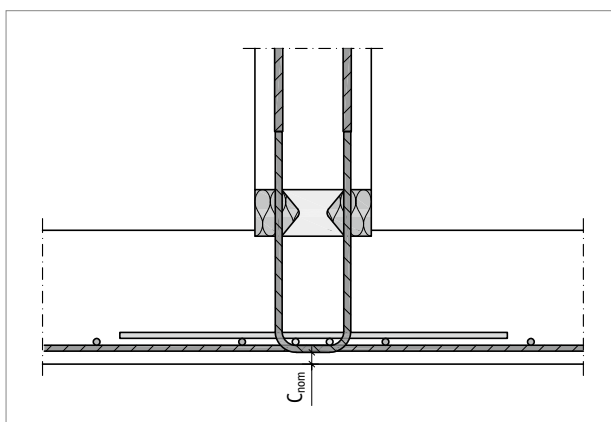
Schöck Sconnex® Typ W-N1T1-BW: Die zweite Bewehrungslage ist in den Schöck Sconnex® Bügel eingefädelt
